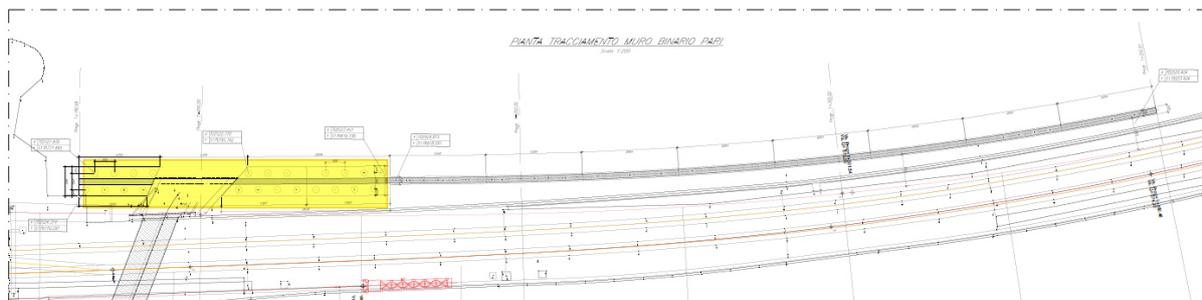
Individuazione Muro di scavalco in c.a. su fondazioni profonde – Planimetria
